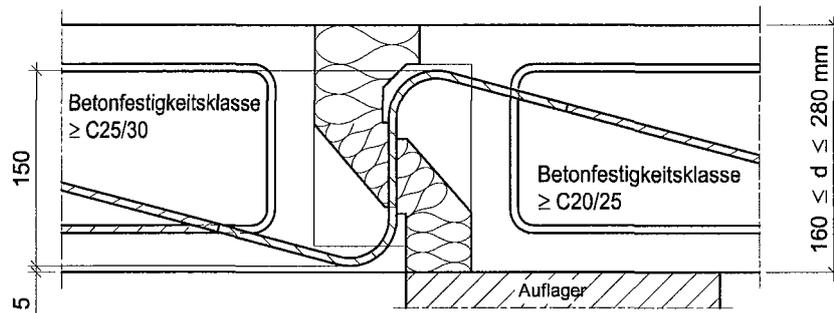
Beispiel Schöck Isokorb Typ V mit Aufhängebewehrung nach Abschn. 3.2.1
